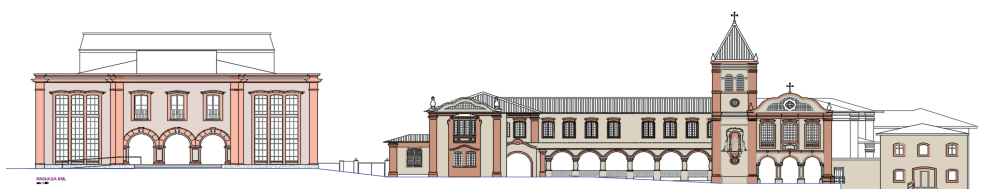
Fachadas voltadas para a rua Monte Alegre. Fonte: Acervo FUNDASP.
